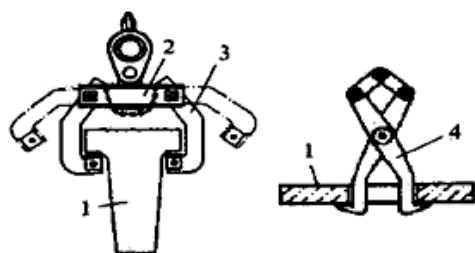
Клепачные захваты: 1 – монтируемый элемент конструкции; 2 – траверса; 3 – механический захват; 4 – распорный клепачный захват
